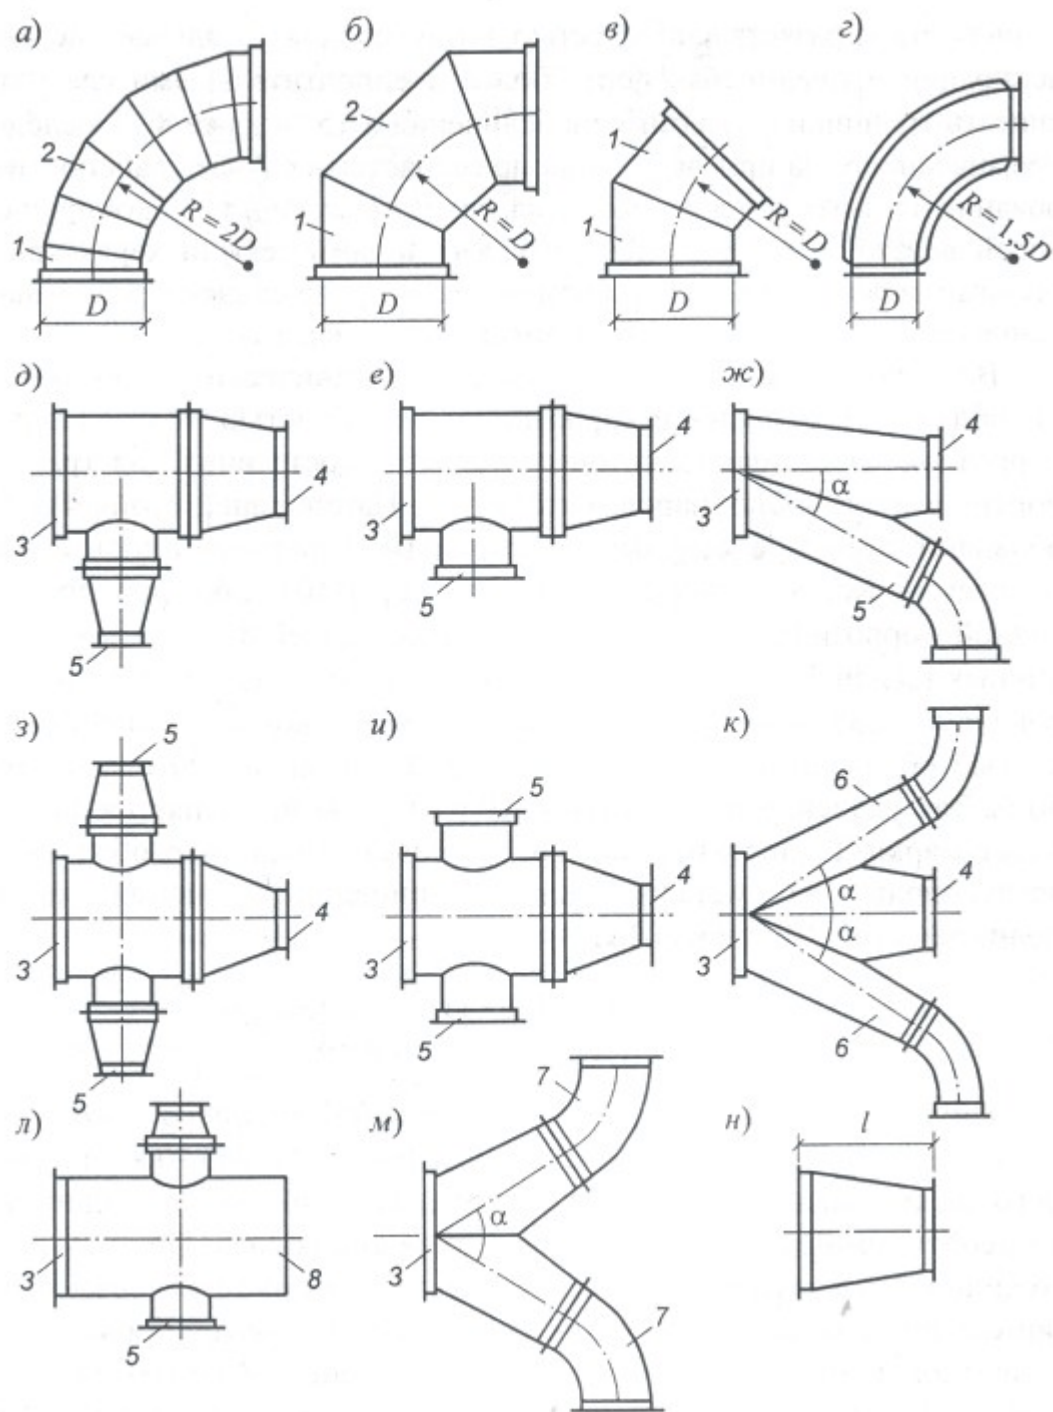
Фасонные части круглых стальных воздуховодов.
